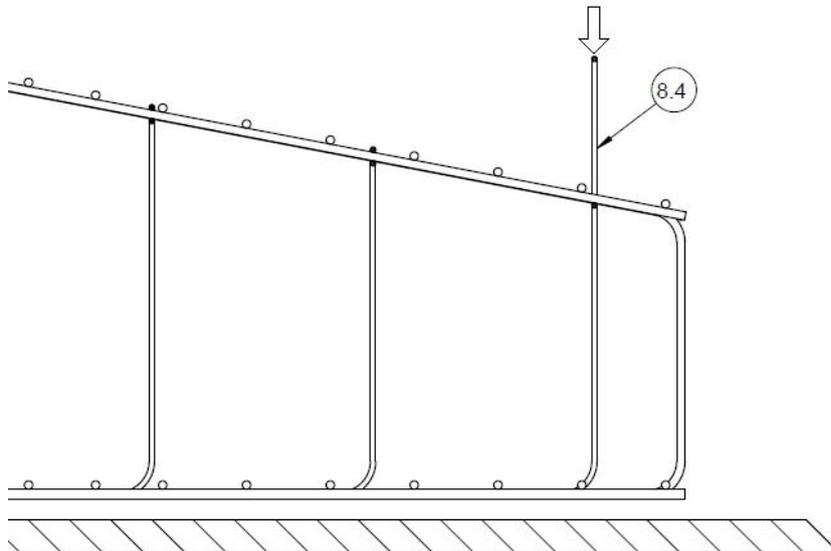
Installation der Haarnadeln in der oberen Bewehrungslage.
